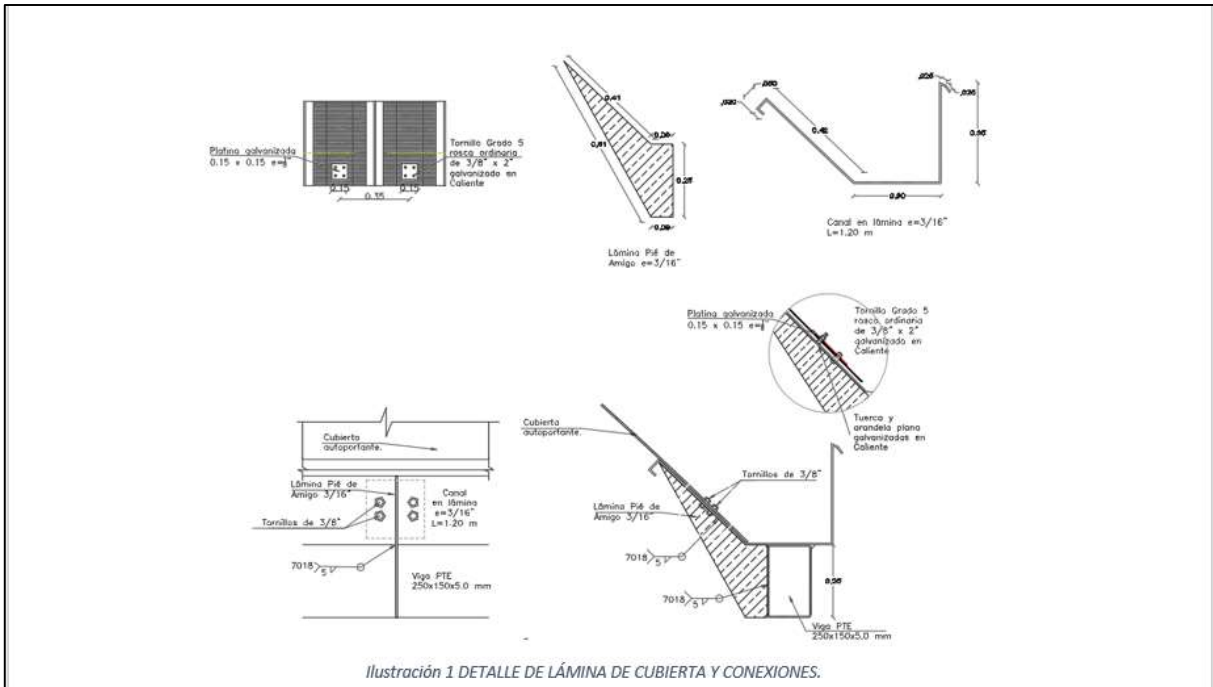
DETALLE DE LÁMINA DE CUBIERTA Y CONEXIONES.
